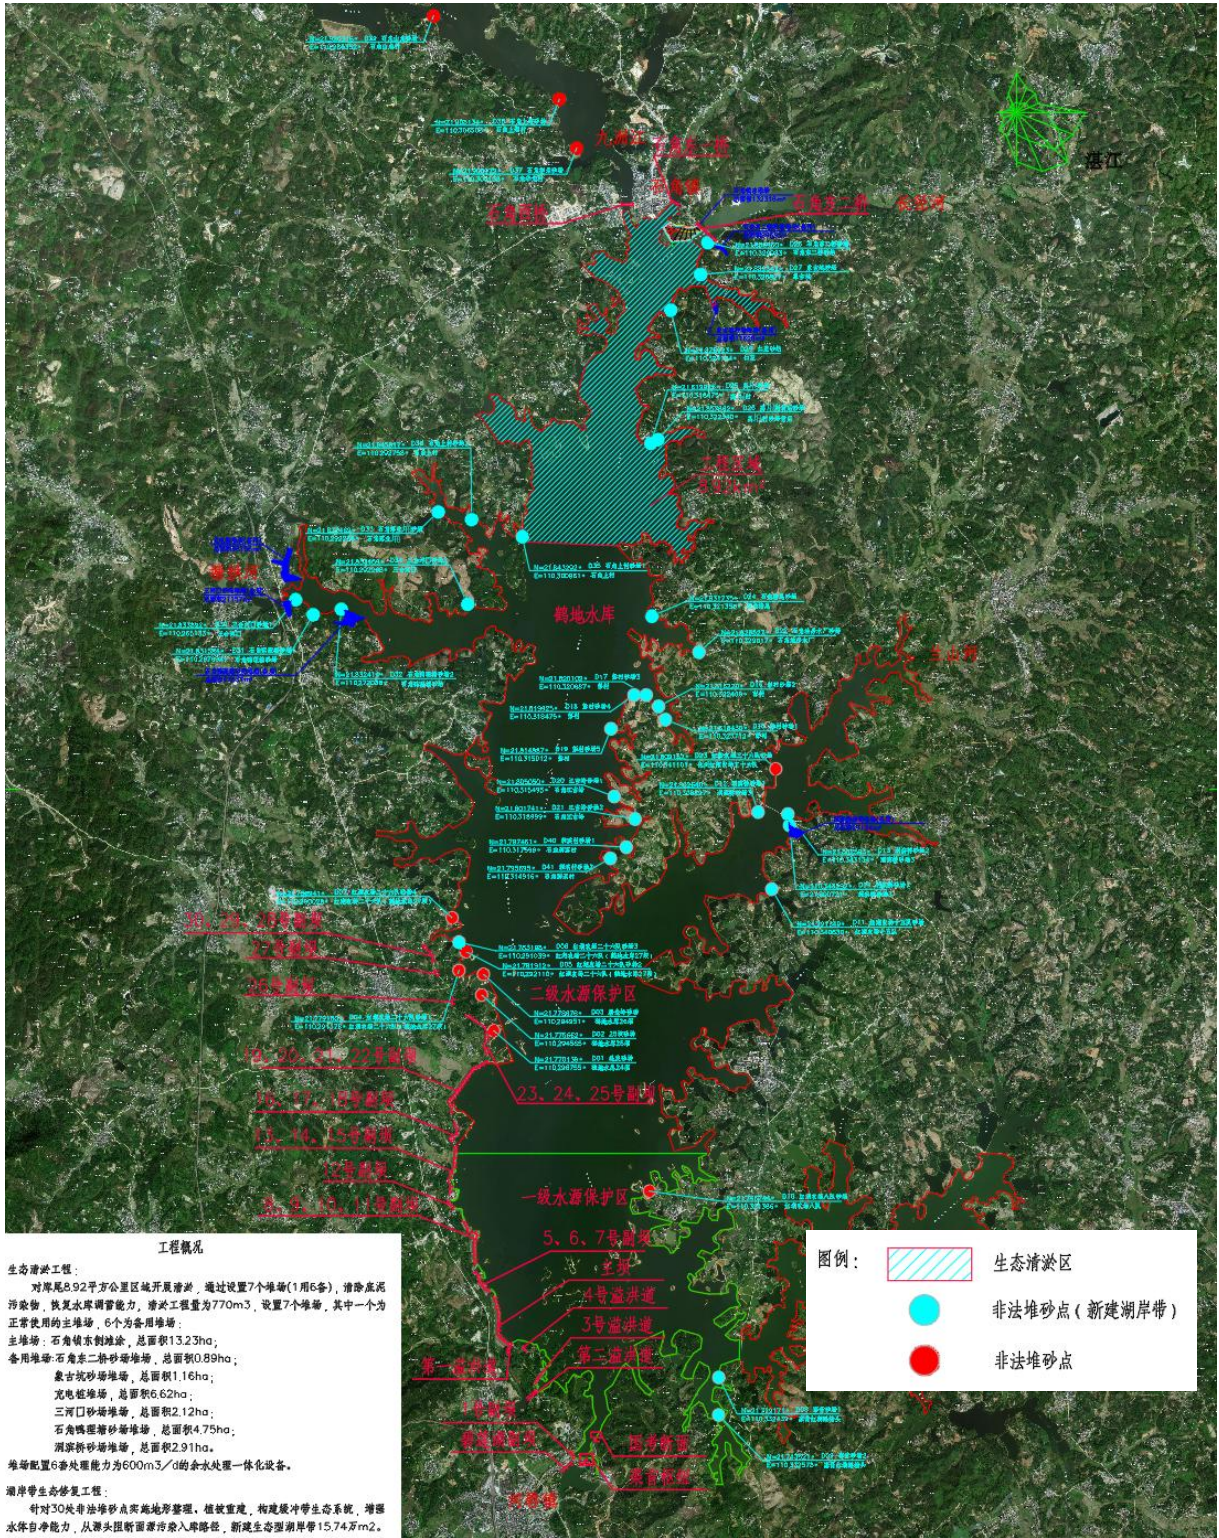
广东省鹤地水库生态保护修复工程总平面布置图
